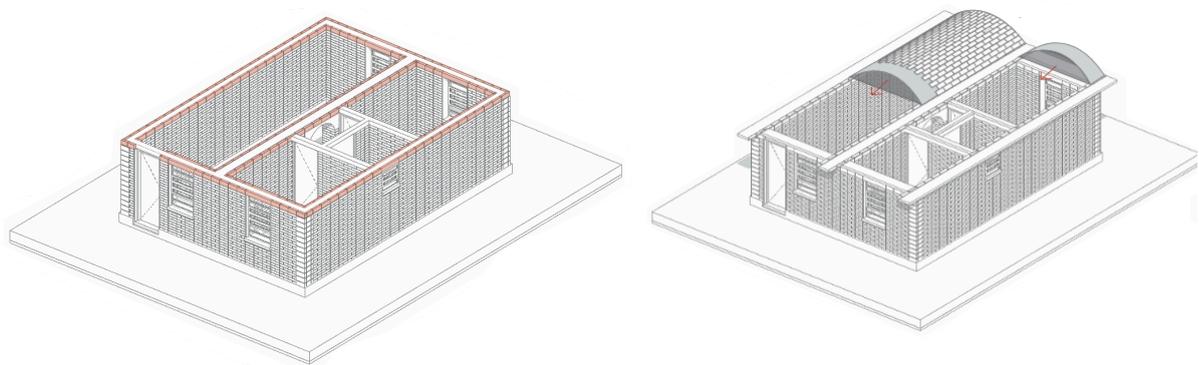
Paginação dos tijolos da viga e vigas de amarração Fonte: Elaborado pelo autor
